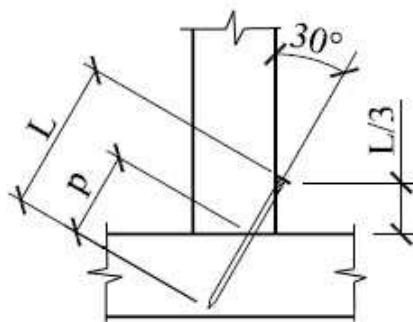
Схема соединения фермы с верхней обвязкой стен – несущую способность гвоздя на сдвиг определим по рекомендациям п. 5.3: длина гвоздя в основном элементе (деревянной обвязке по верху стены)
